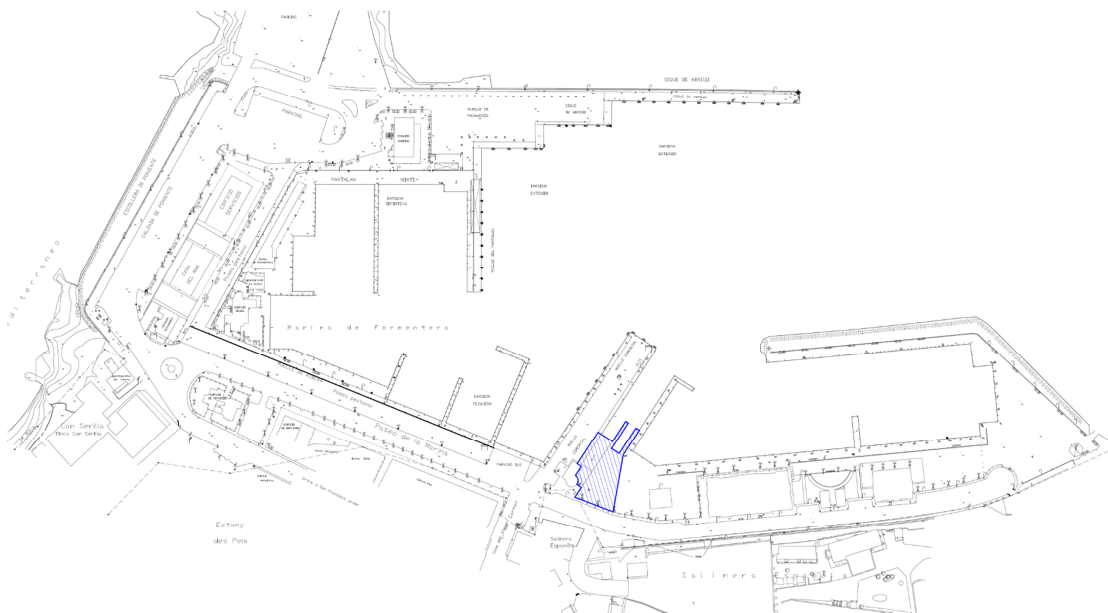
Situación y ámbito del presente proyecto de ejecución.
